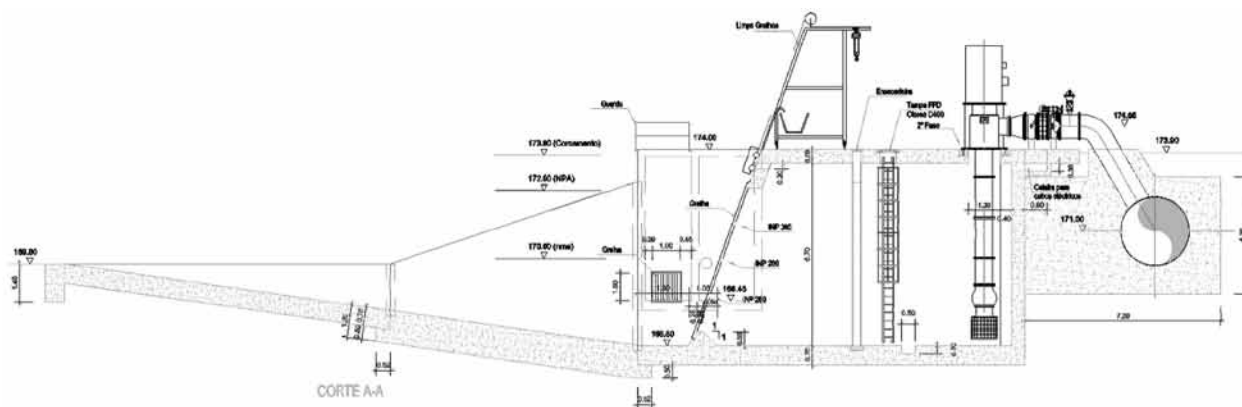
Estação Elevatória do Álamo – Solução com grupos verticais
